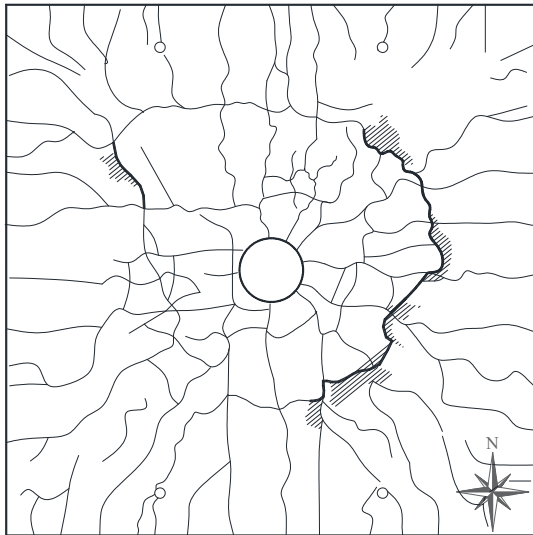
Mapa de fissuração da laje RSP28
